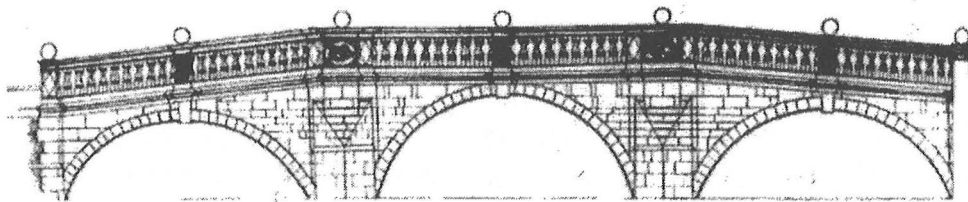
Südansicht der Clare College Brücke, die Verzerrungen zeigend.
